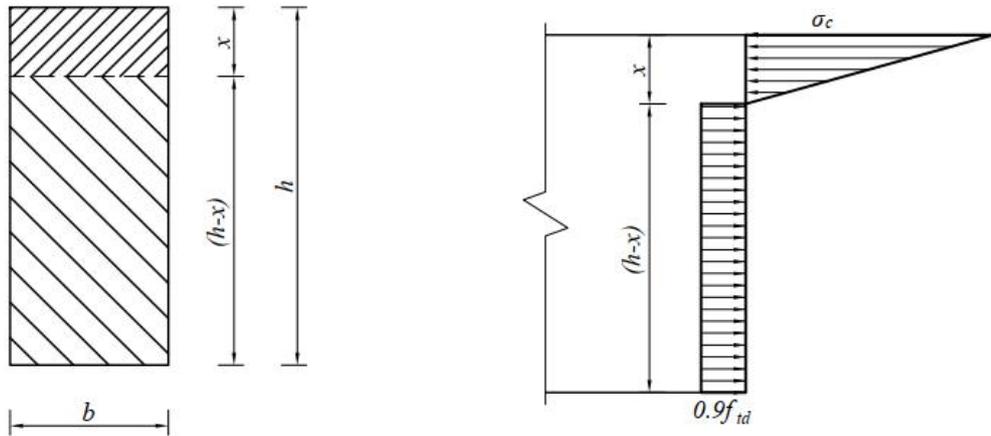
未配置钢筋、预应力钢束的矩形截面受弯构件受弯承载力计算
